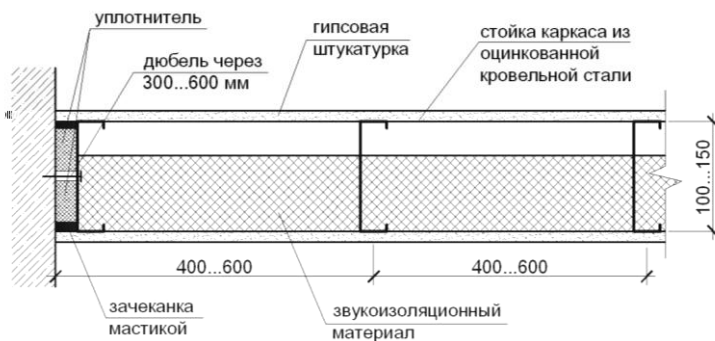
Горизонтальное сечение по каркасной перегородке
